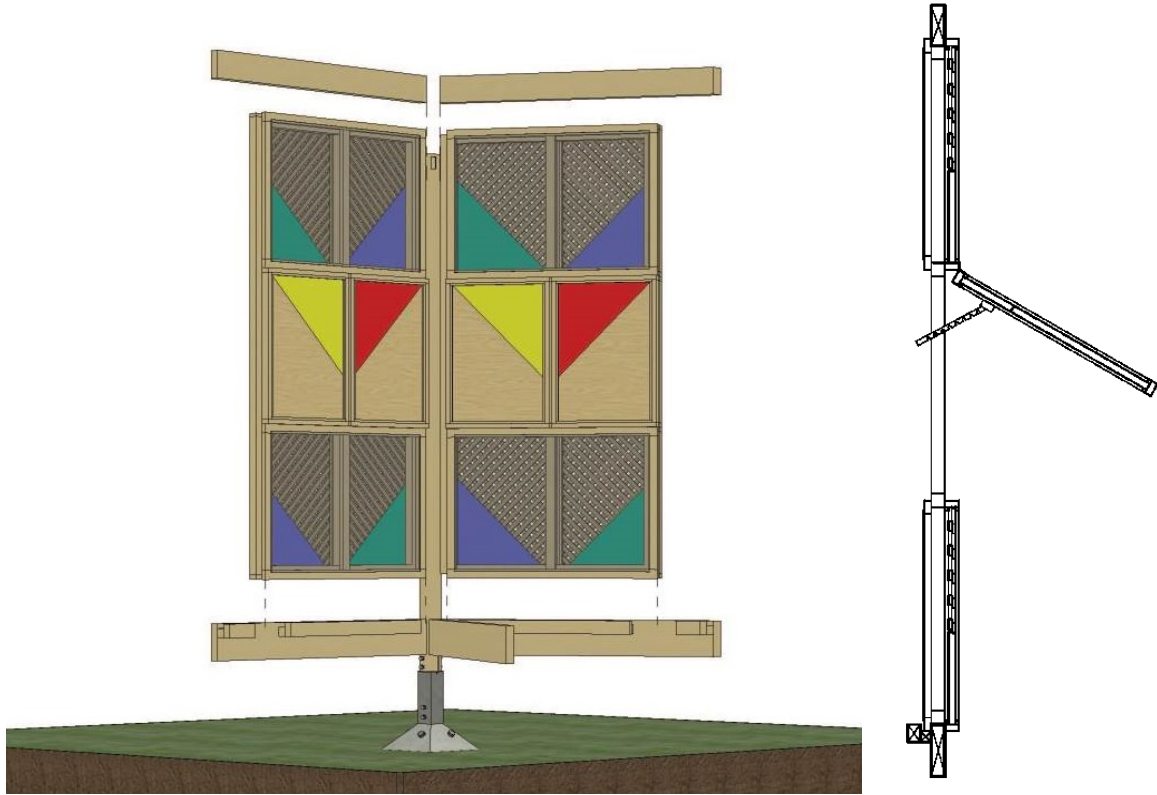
Ensamble de viga – panel de cerramiento - viga<sup>221</sup>
